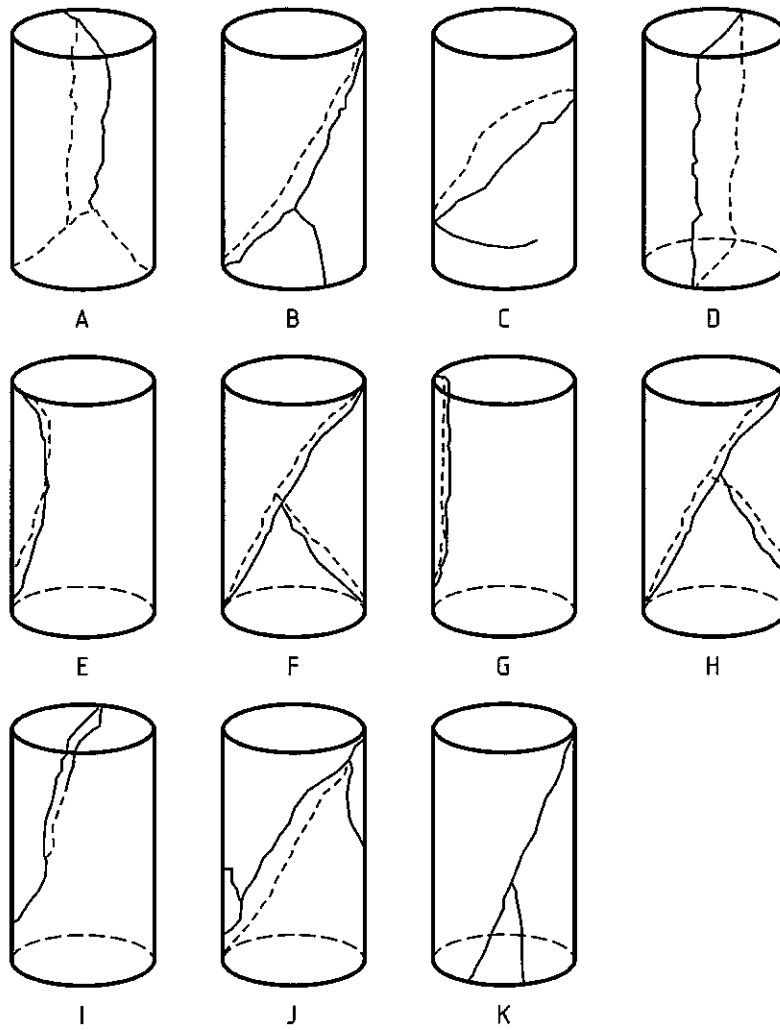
Exemples de ruptures incorrectes d'éprouvettes cylindriques
